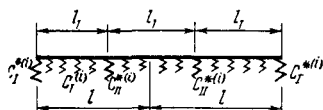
Расчетная схема перекрытия для здания с четырьмя диафрагмами жесткости.
